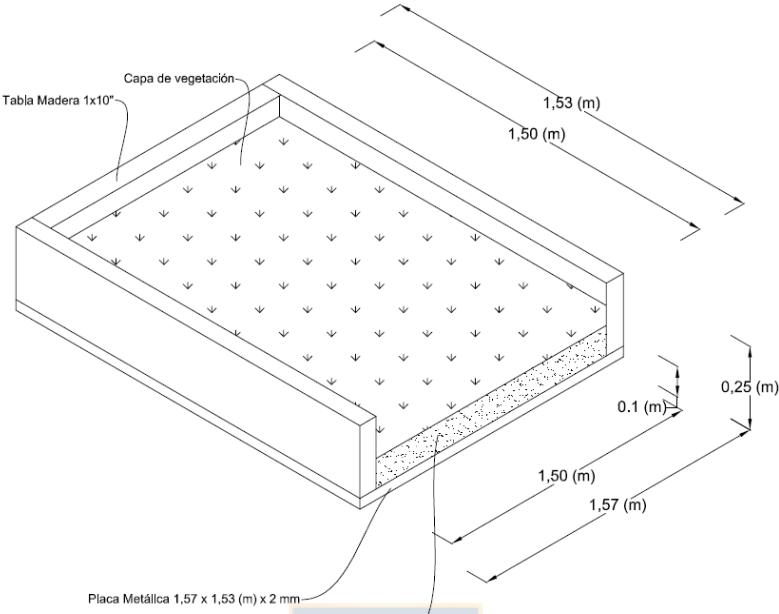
Dimensiones del módulo de Cubierta Verde. Fuente: Elaboración Propia
